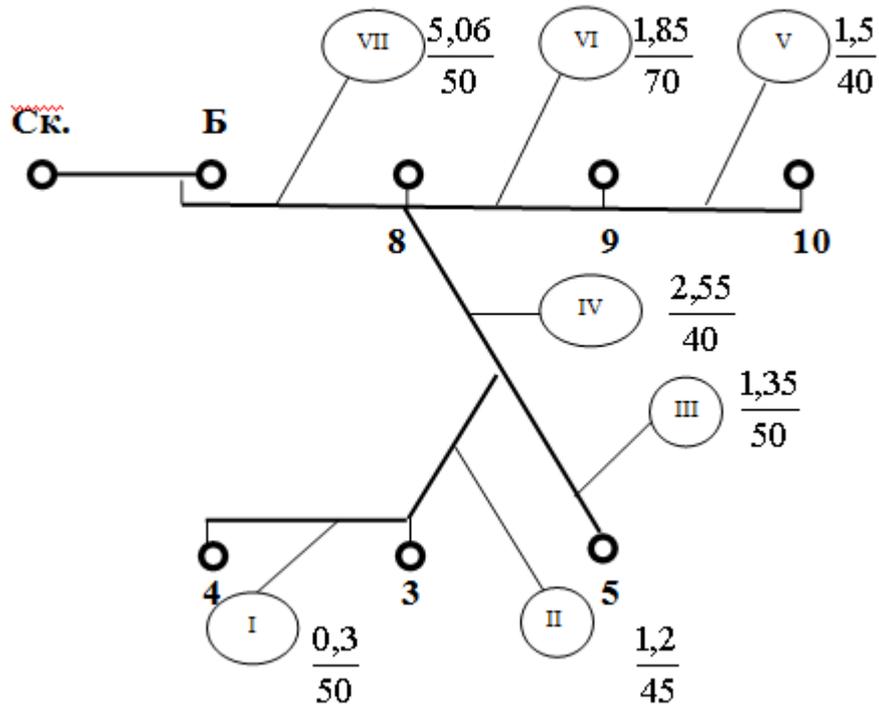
Расчетная схема водопроводной сети с транзитными участками.
